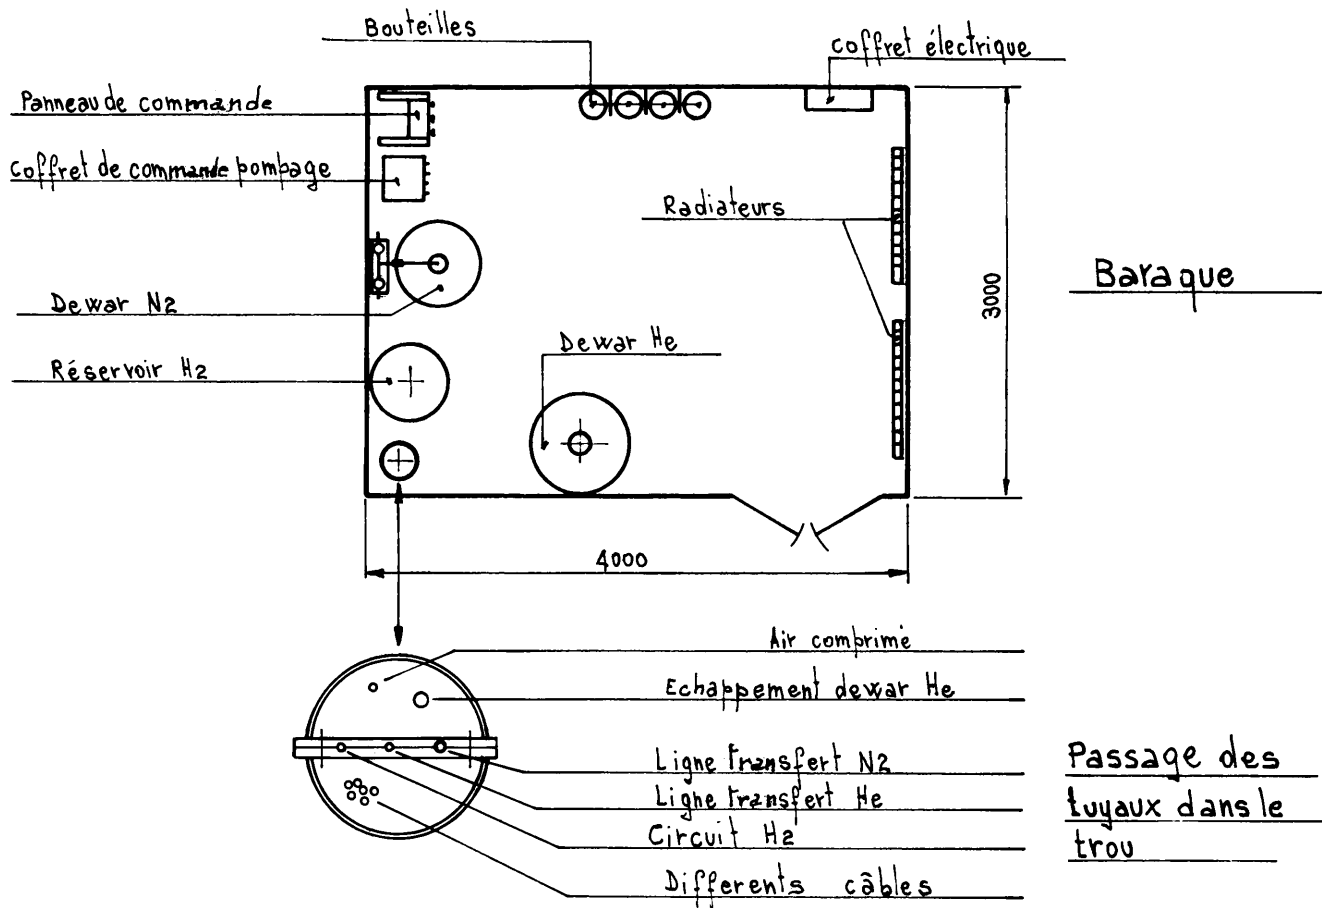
Plan de la baraque et coupe verticale de l'anneau par rapport à la cible.
